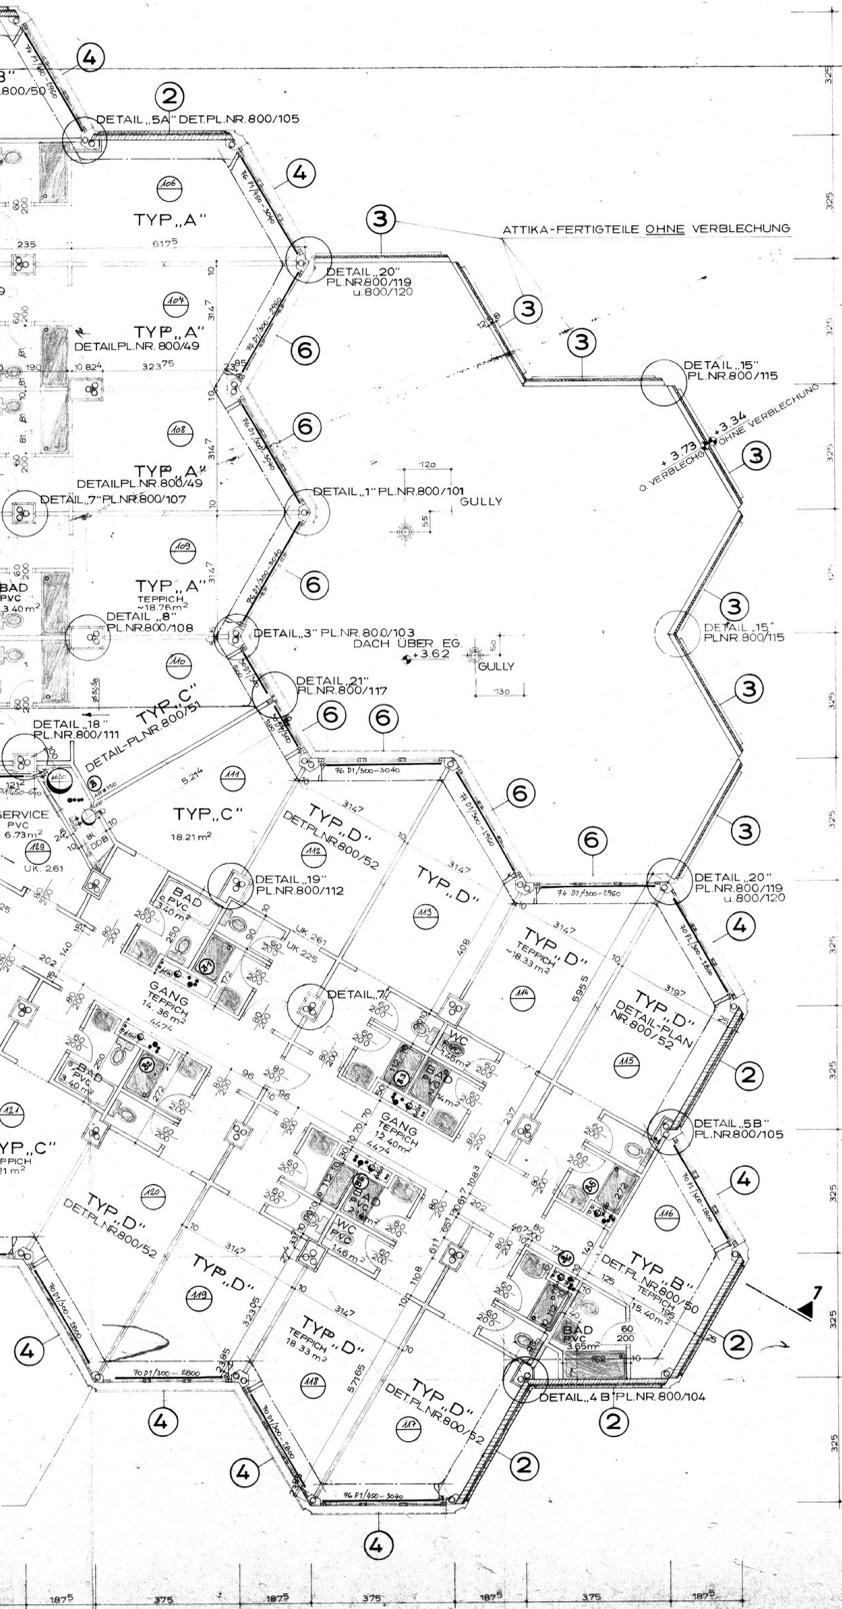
Grundriss 1. Obergeschoß MST 1:250
